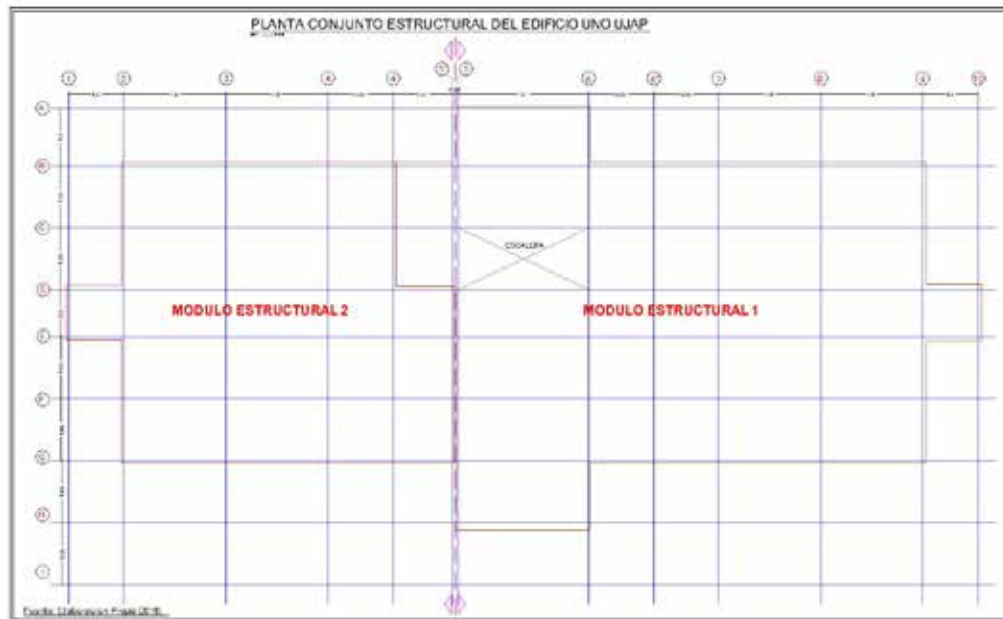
Vista de Planta Conjunto Estructural Edificio Uno UJAP
